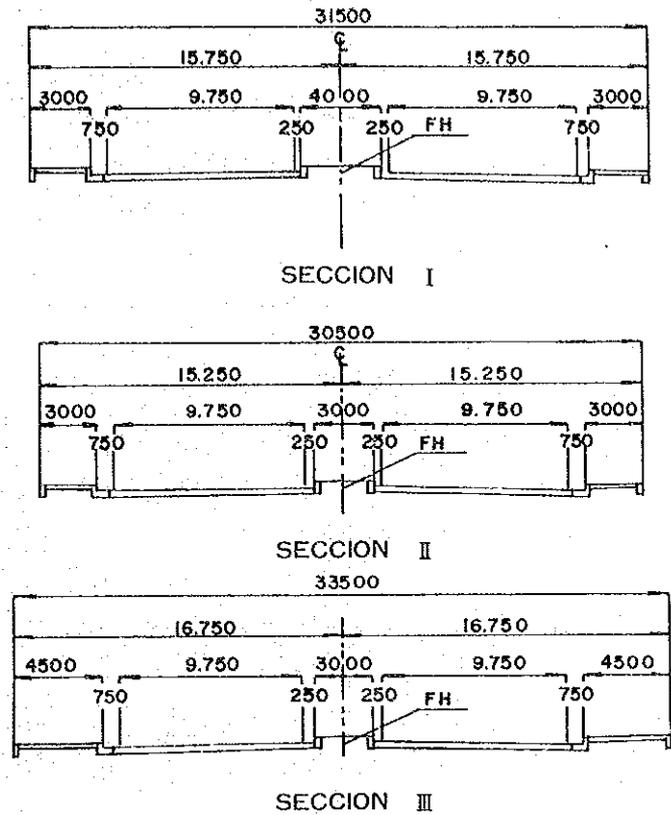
SECCION DE CONSTRUCCION DE LA CALLE 30
